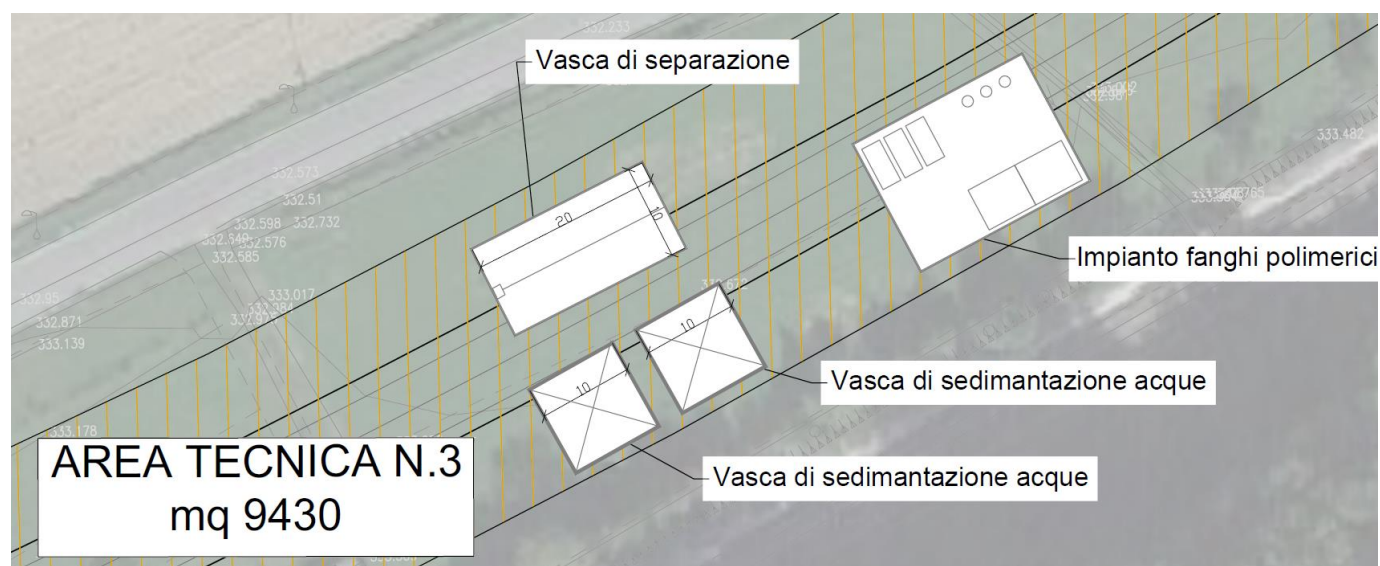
Stralcio planimetria aree di cantiere – Vasche di separazione e sedimentazione fluidi di perforazione
